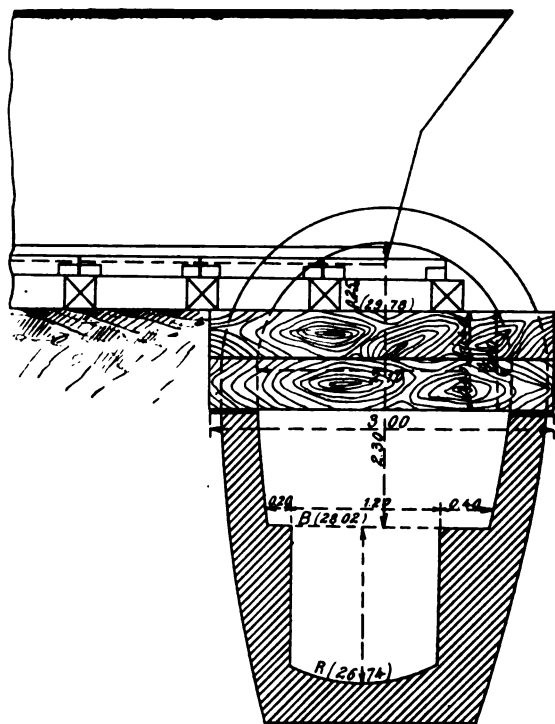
Franchissement du collecteur de l'Université. Coupe longitudinale sur l'axe du collecteur de Bièvre.
